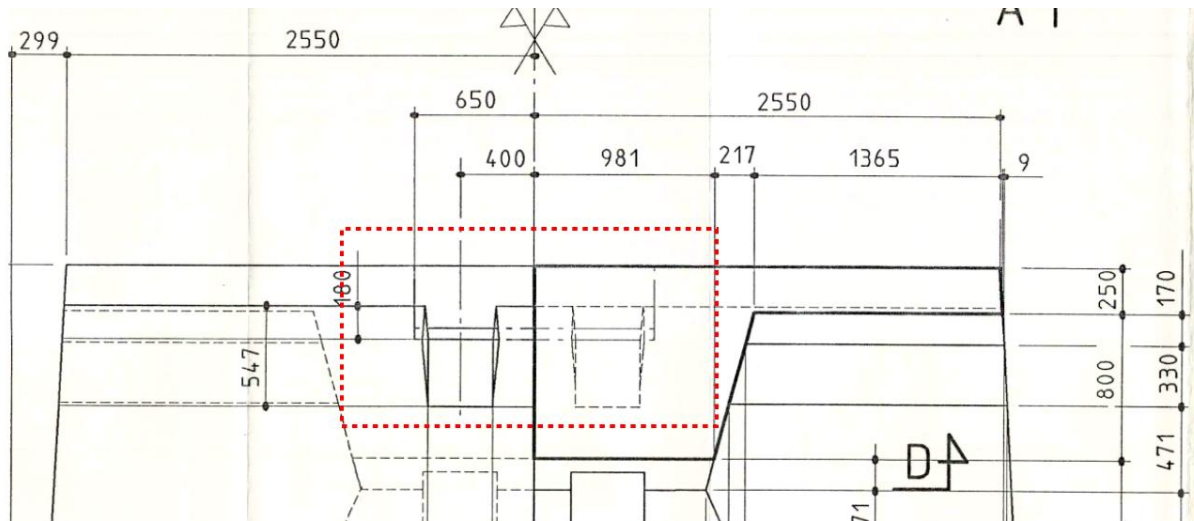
coffrage VSP – coupe longitudinale - double nervure sous encorbellement à l'axe des piles
